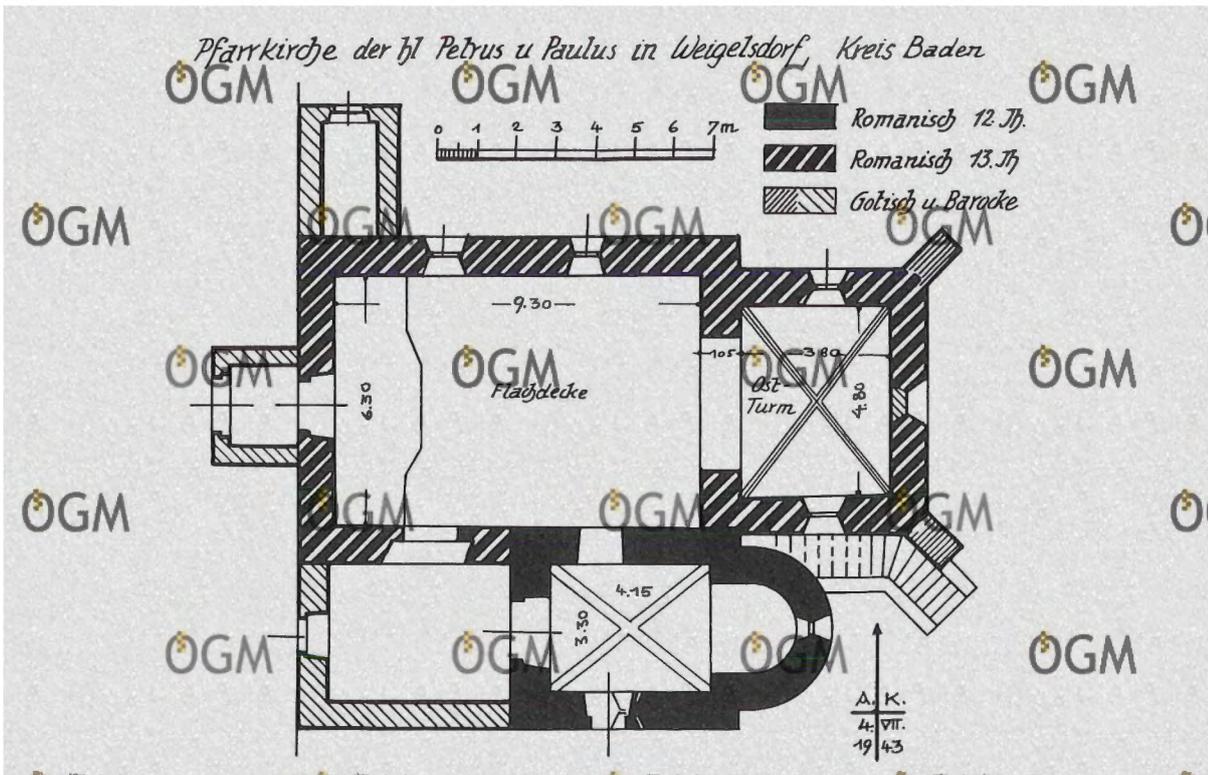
Weigelsdorf, NÖ. Baualterplan von Adalbert KLAAR. (Plan: Bundesdenkmalamt - Planarchiv).
